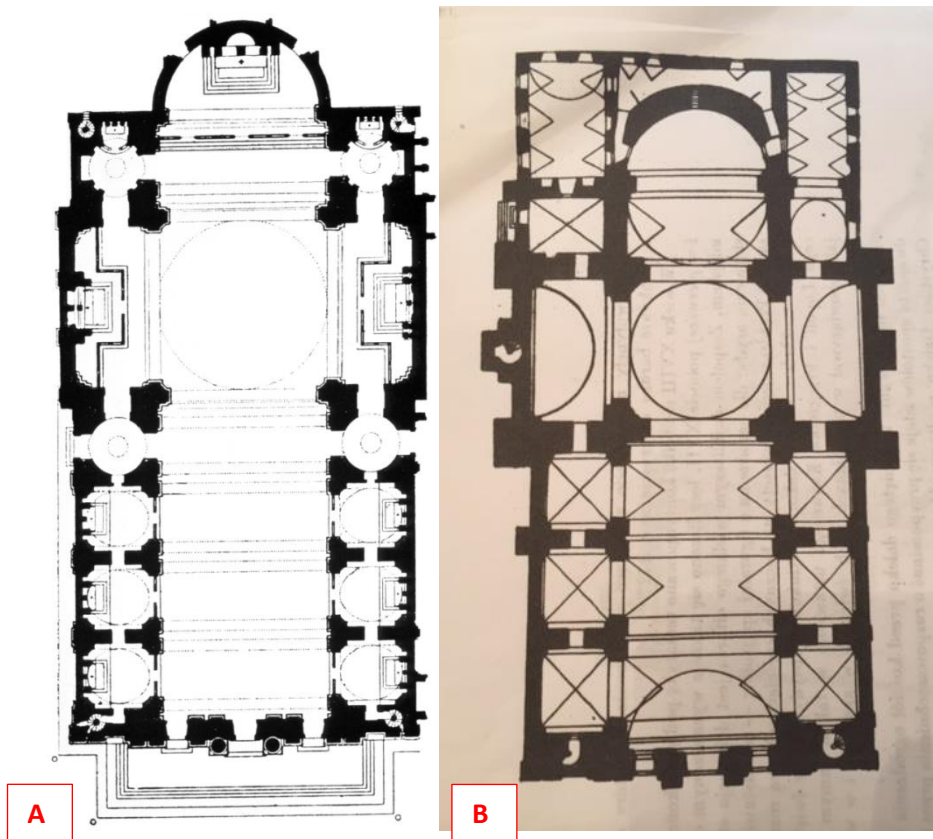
Grundrisse „A“ Il Gesù, Rom, „B“ SS. Peter und Paul, Krakau.
